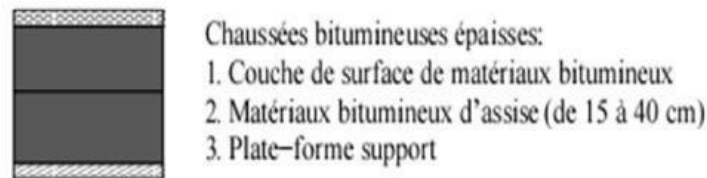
représentation de la structure d'une chaussée bitumineuse épaisse [5]
